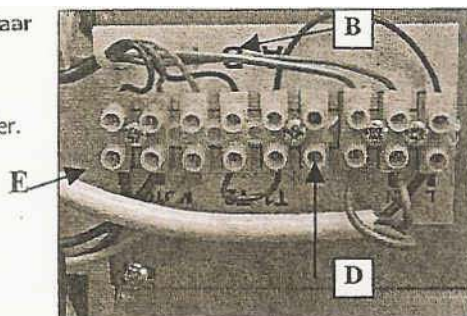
De kroonsteen is nu zichtbaar. Verwijder de doorverbinding tussen T1 en T2. Verwijder de draad uit B en plaats deze in D zoals op foto 6 is aangegeven. Verwijder de draad uit E en monteer deze in B.
